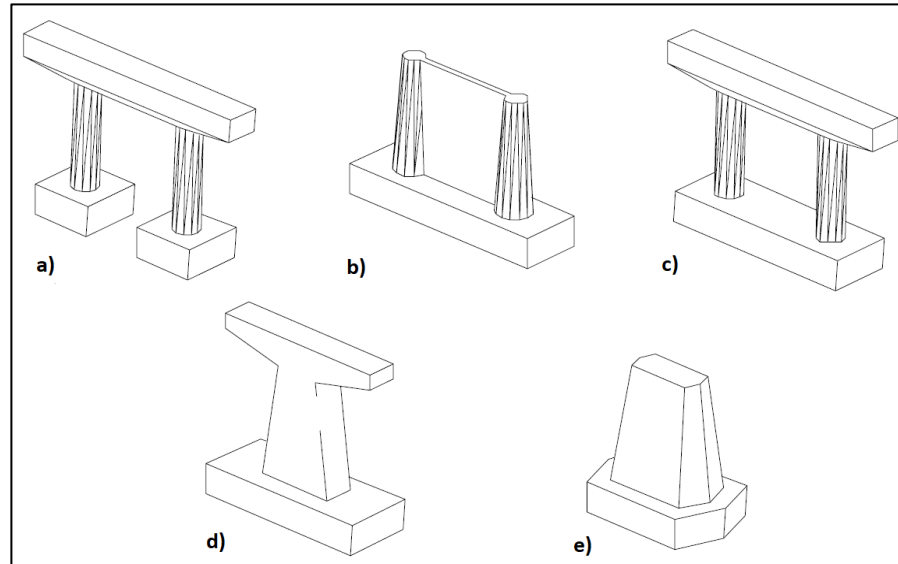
Tipos de pilas. a) Pórtico abierto con viga cabezal, b) Con diafragma, c) Pórtico cerrado con viga cabezal, d) Con viga en voladizo, e) Sólidos.
